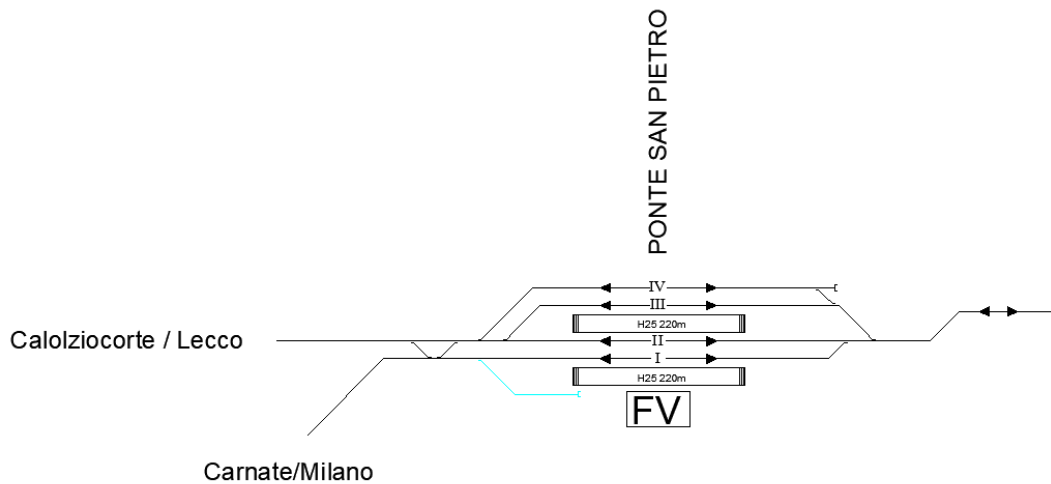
Situazione attuale del lotto oggetto dell'intervento
